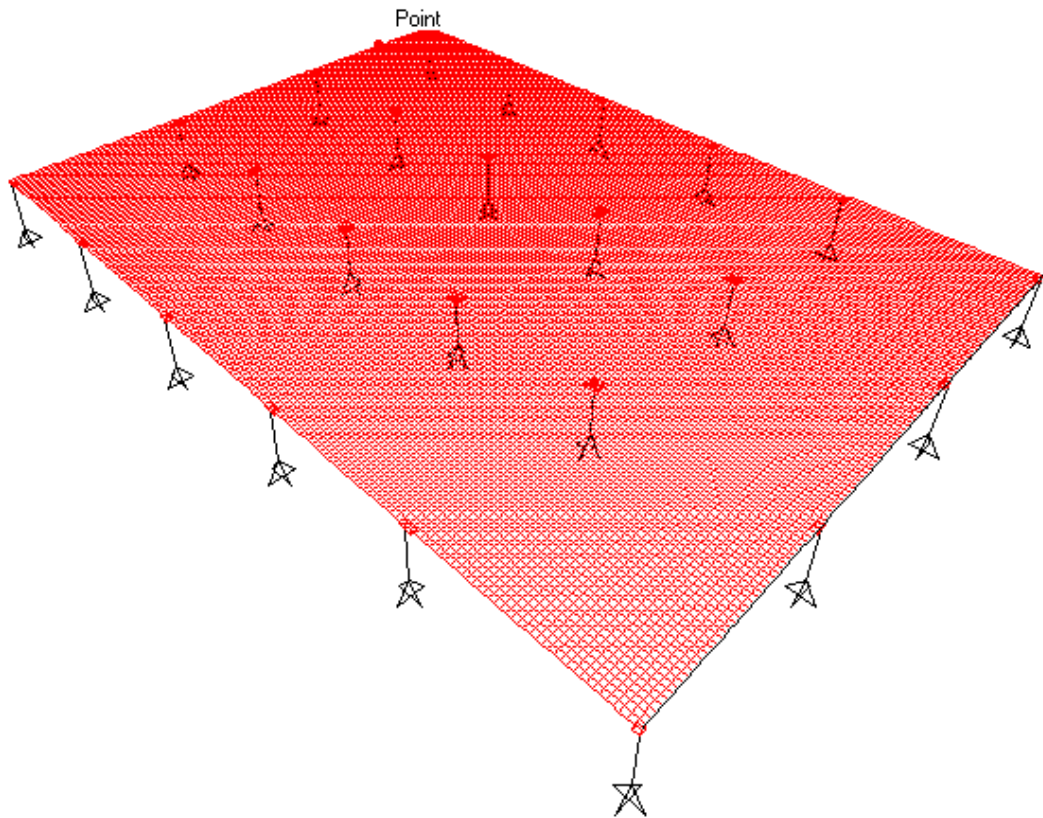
Laje Lisa sobre apoios sólidos + lineares – Vista 3D
